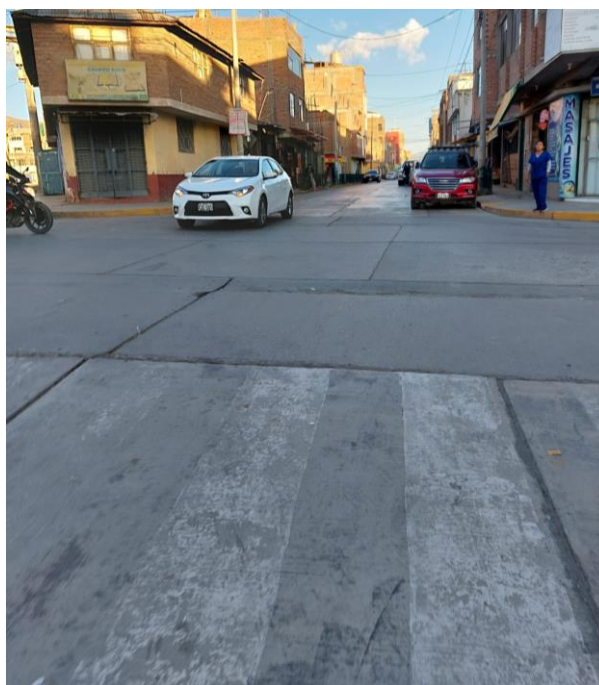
Encuentro de pavimento nuevo y existente fisuras en ambos pavimentos.
